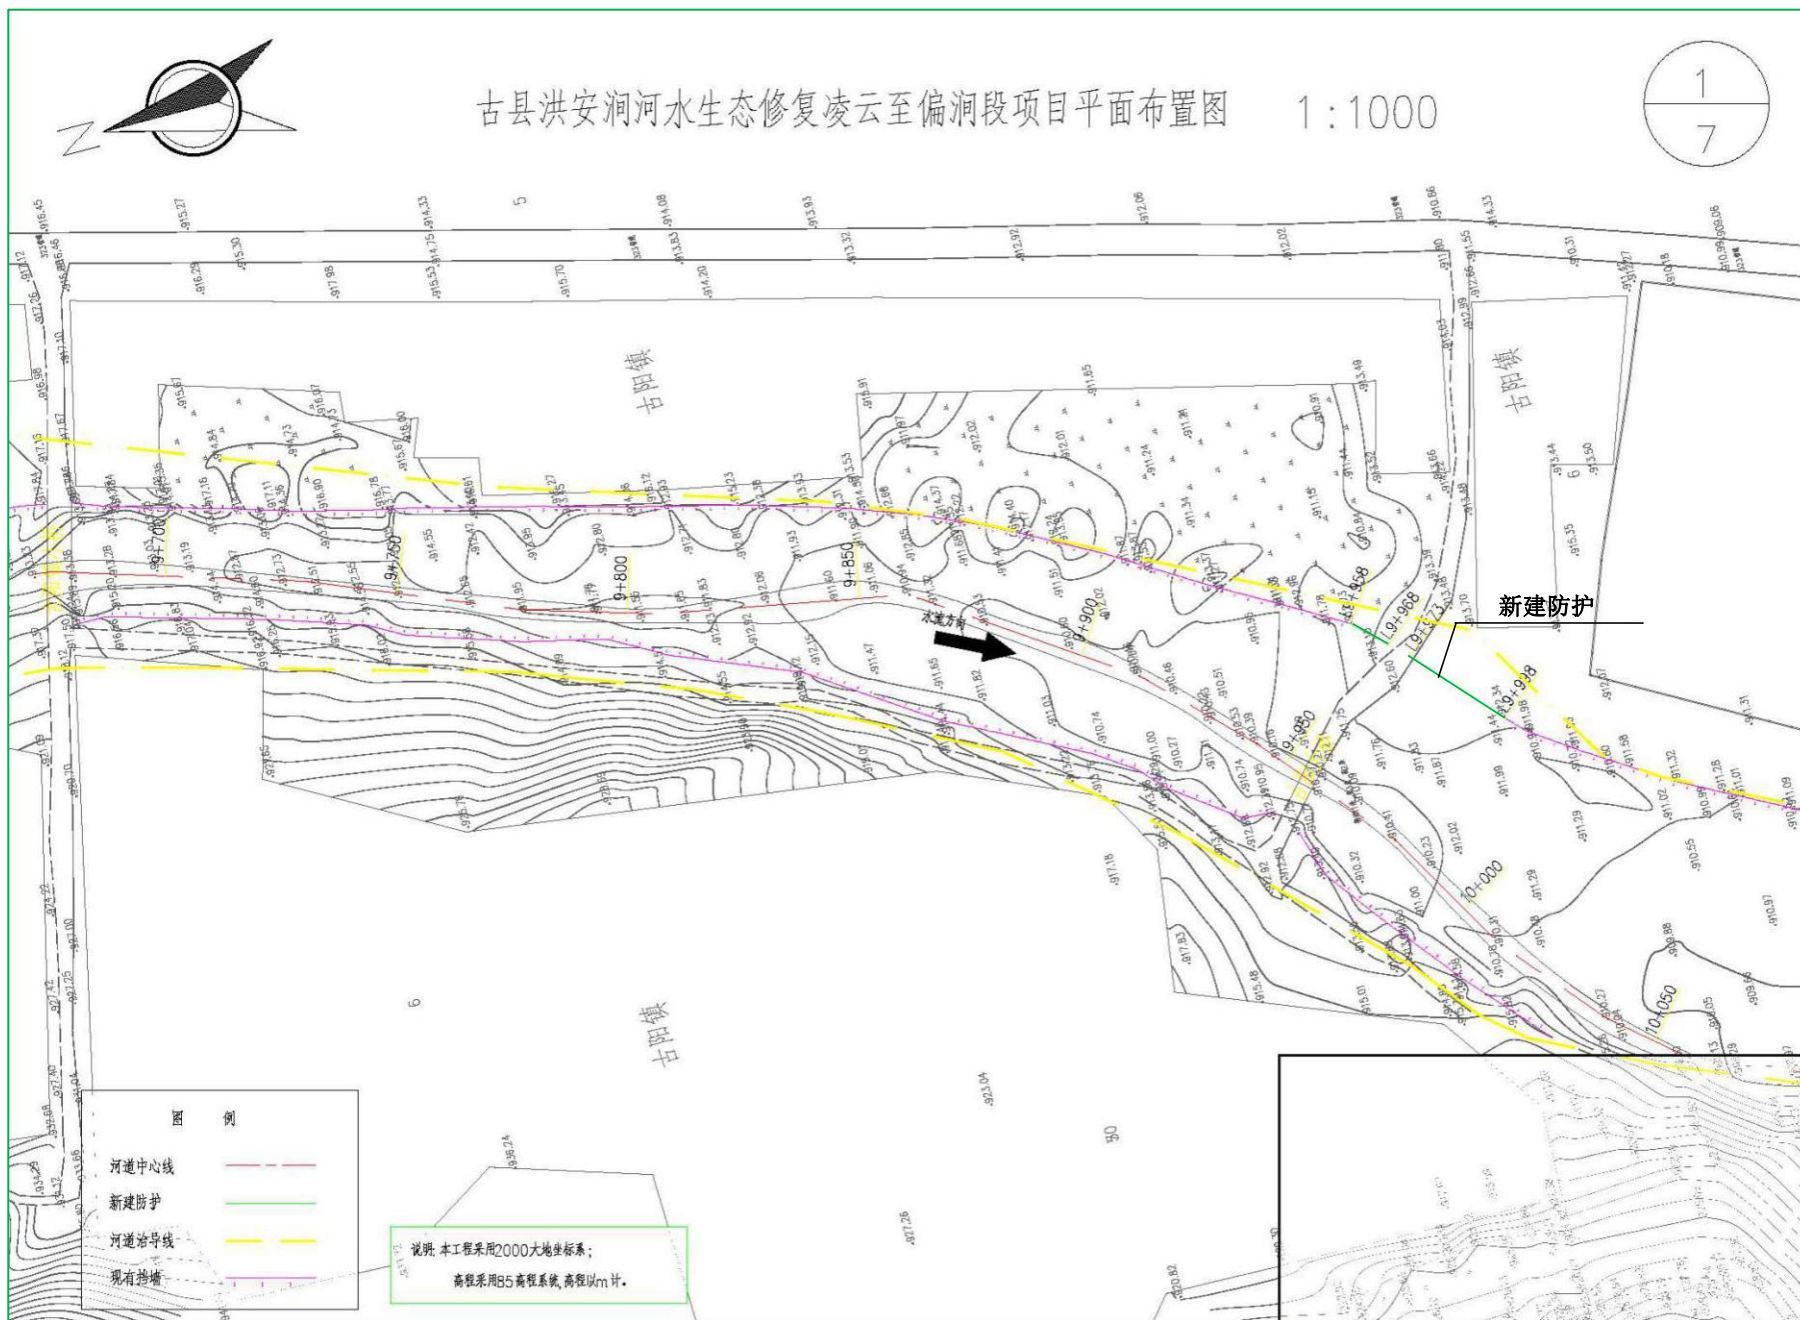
(5) 工程总平面布置图 (桩号 9+700-10+050)
